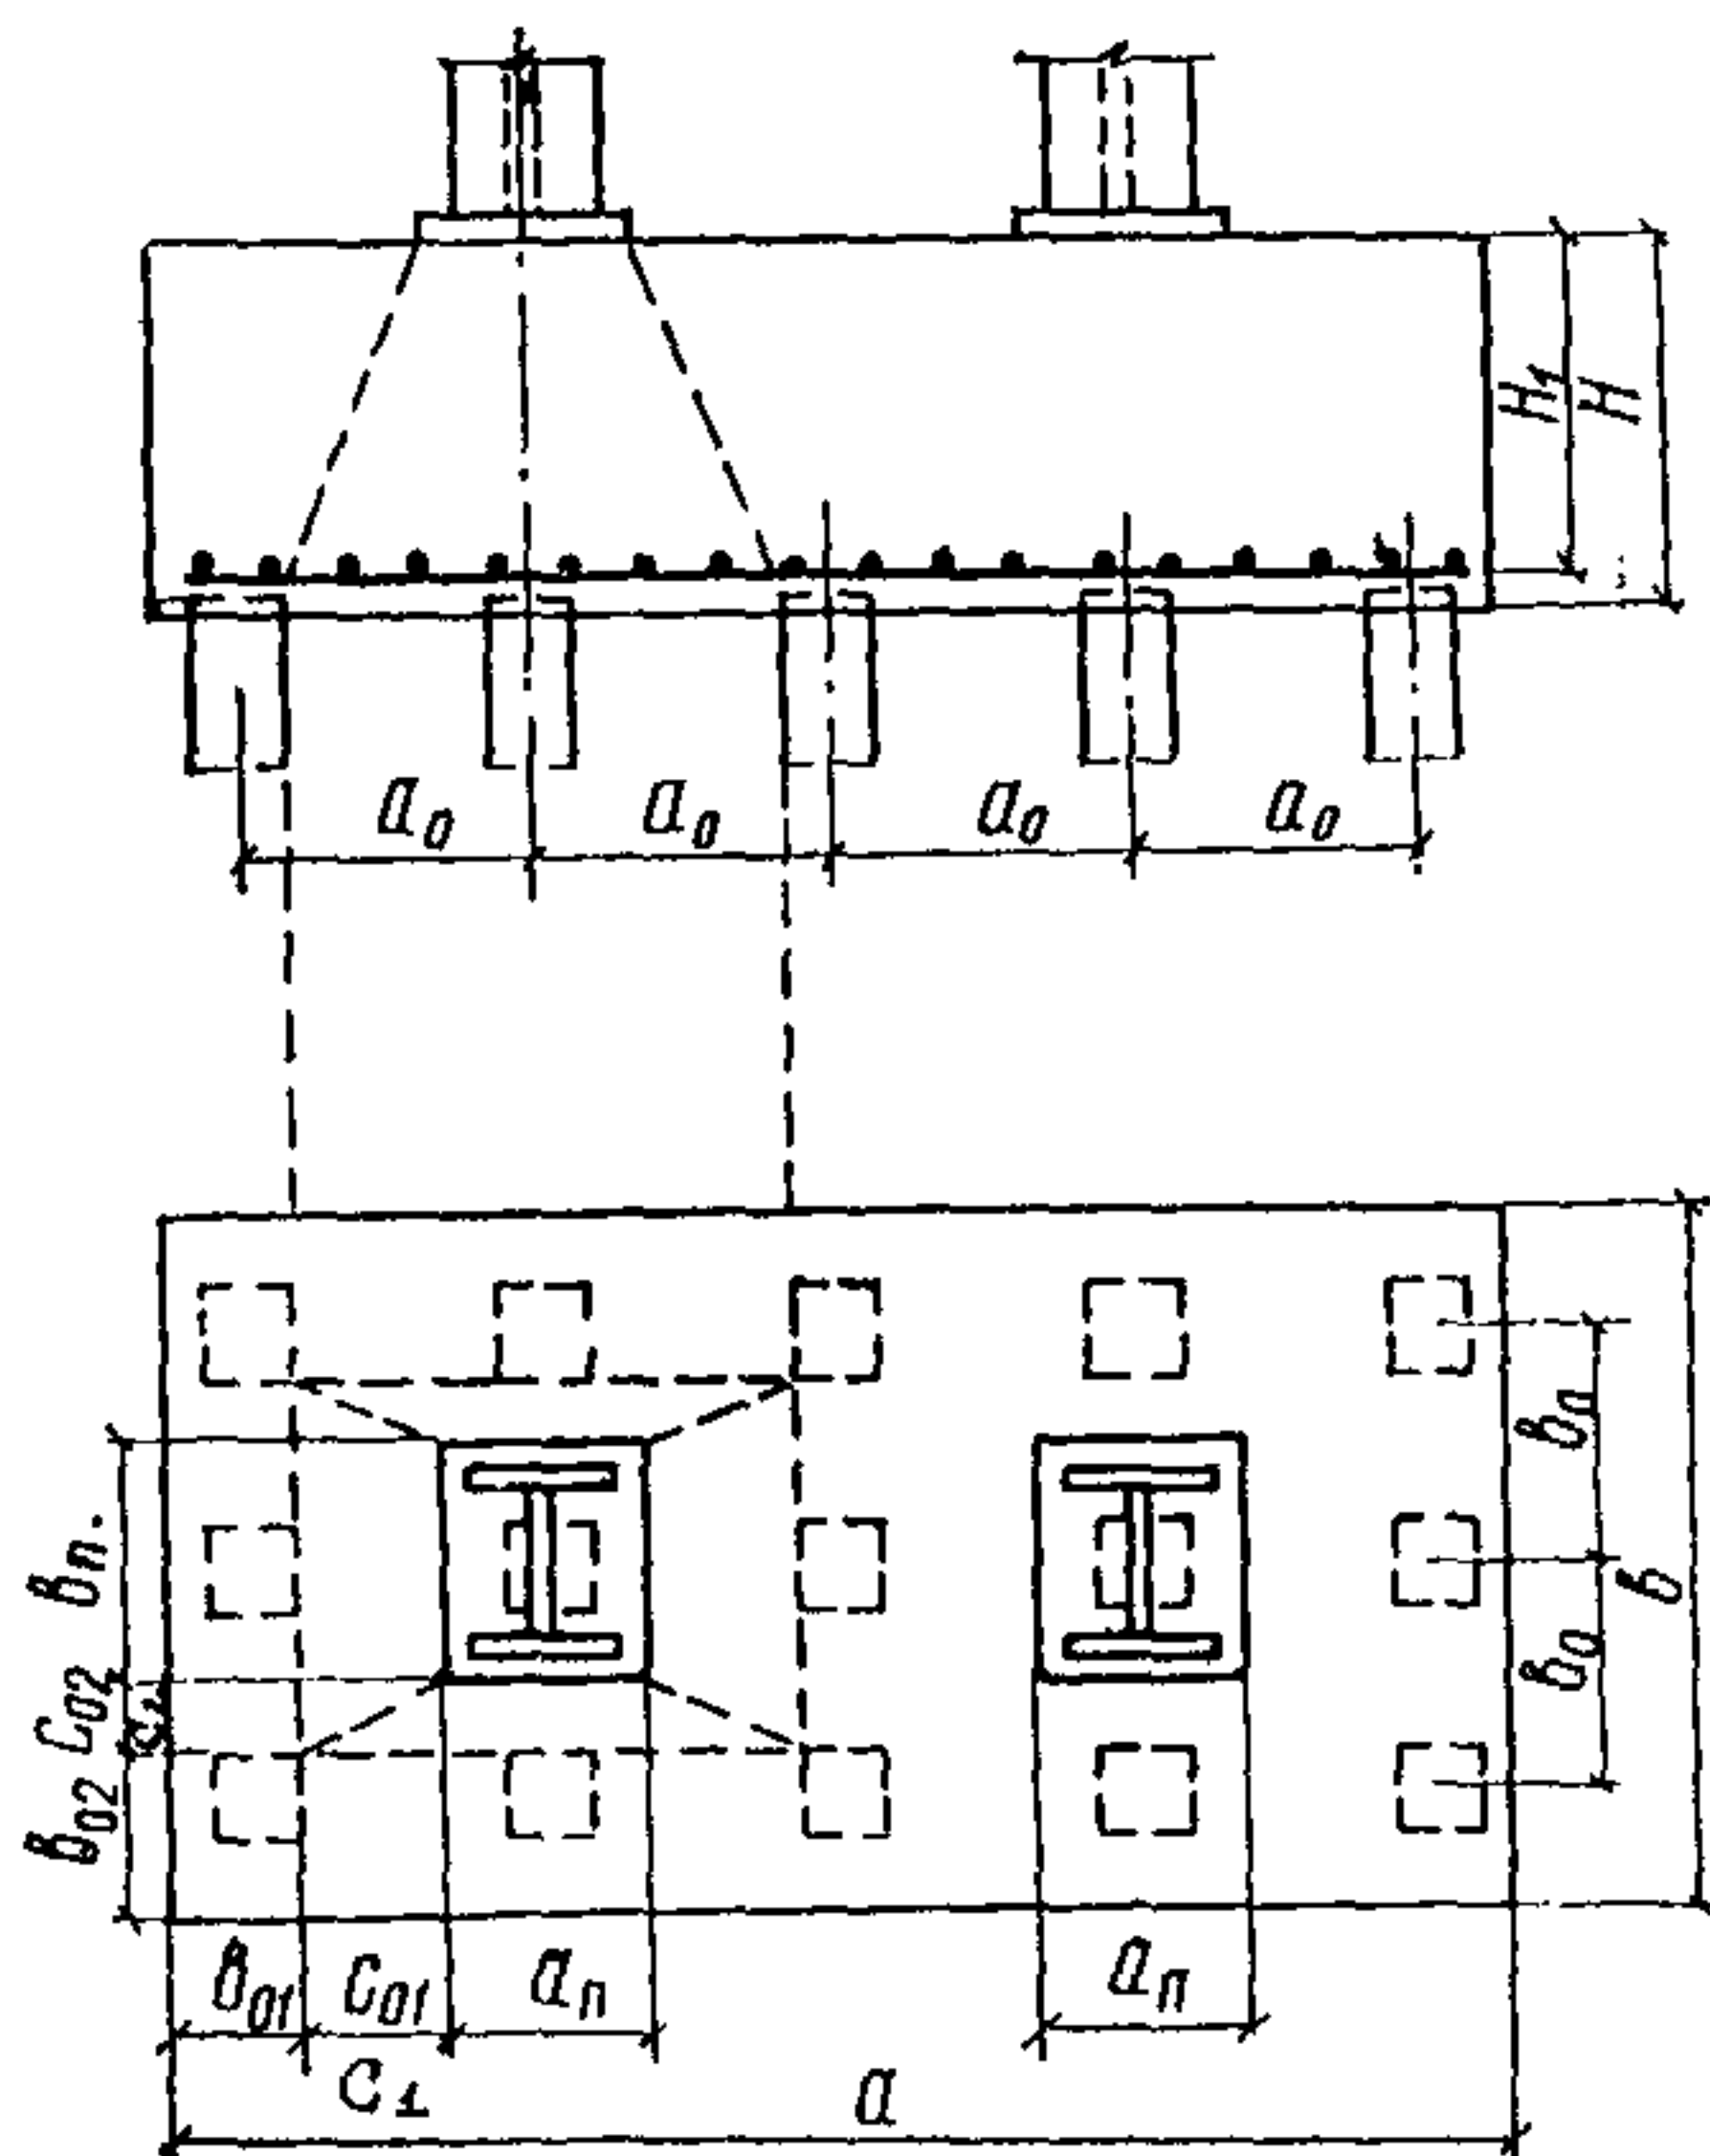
Схема образования пирамиды продавливания при стальных сквозных (решетчатых) колоннах, имеющих отдельные стальные базы под каждой ветвью
